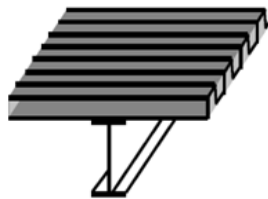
Poutres maintenues latéralement (type tôles nervurées). [14]
